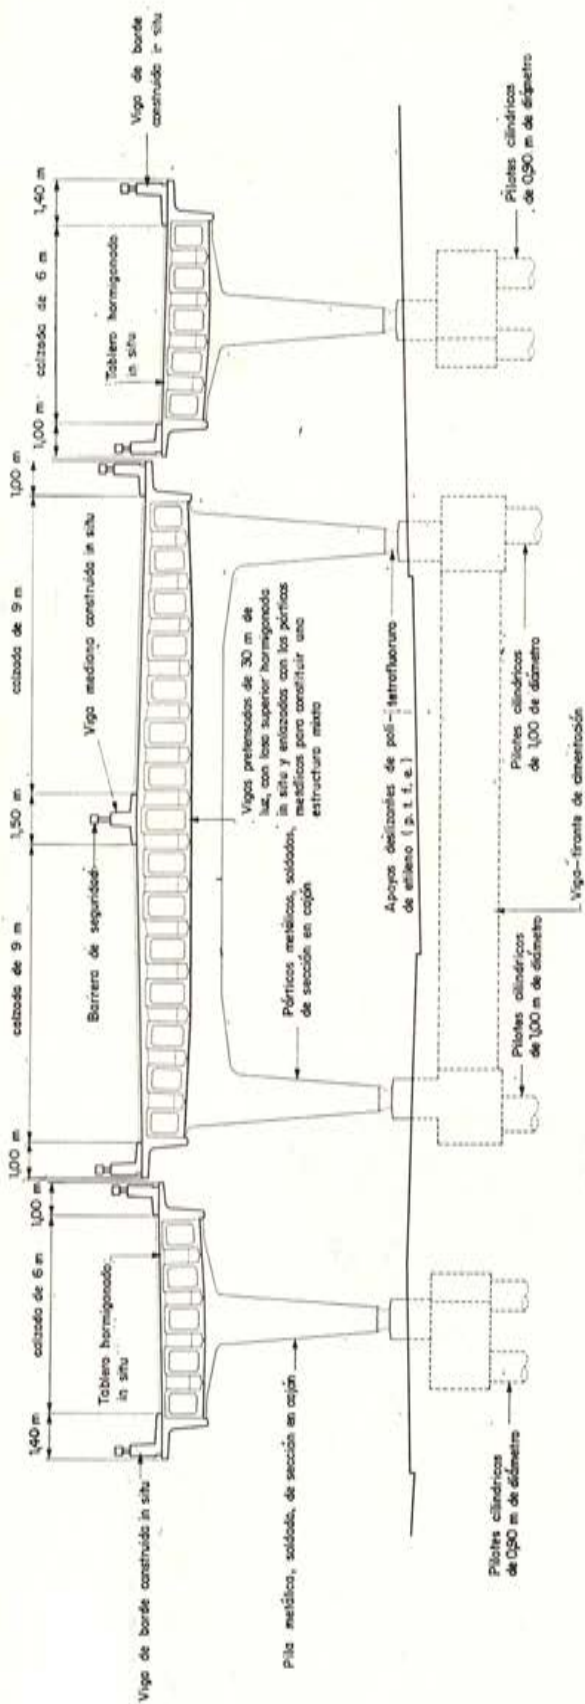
Paso elevado de Westway, en Londres. Sección transversal de la estructura de uno de los tramos de 30 m de luz.
